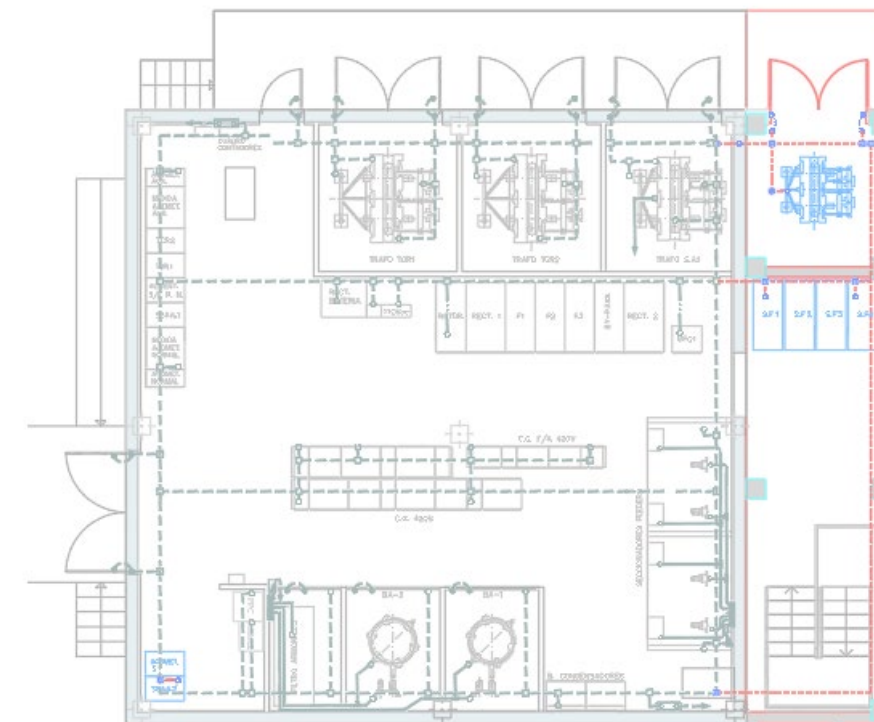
Planta de la puesta a tierra, existente y de nueva ejecución
